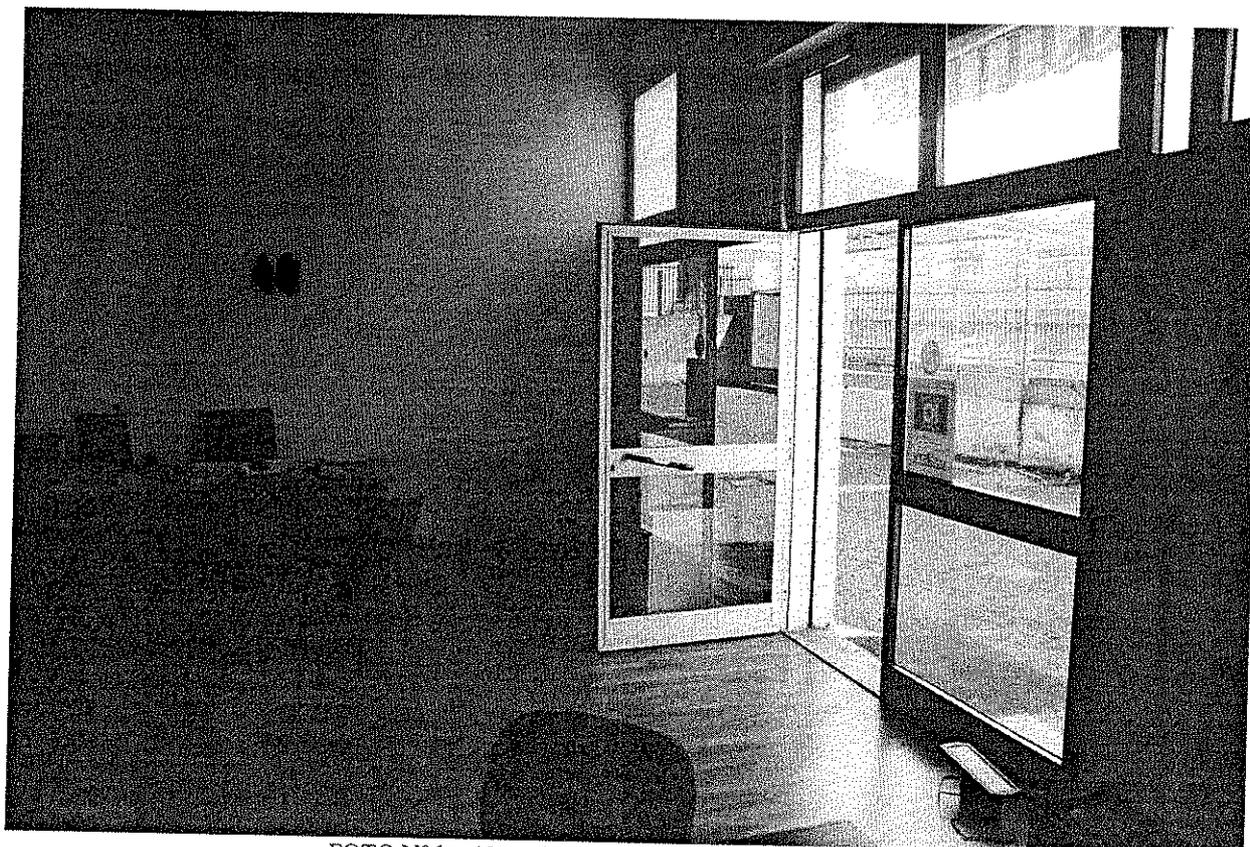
Altra vista *open-space* presente all'ingresso
